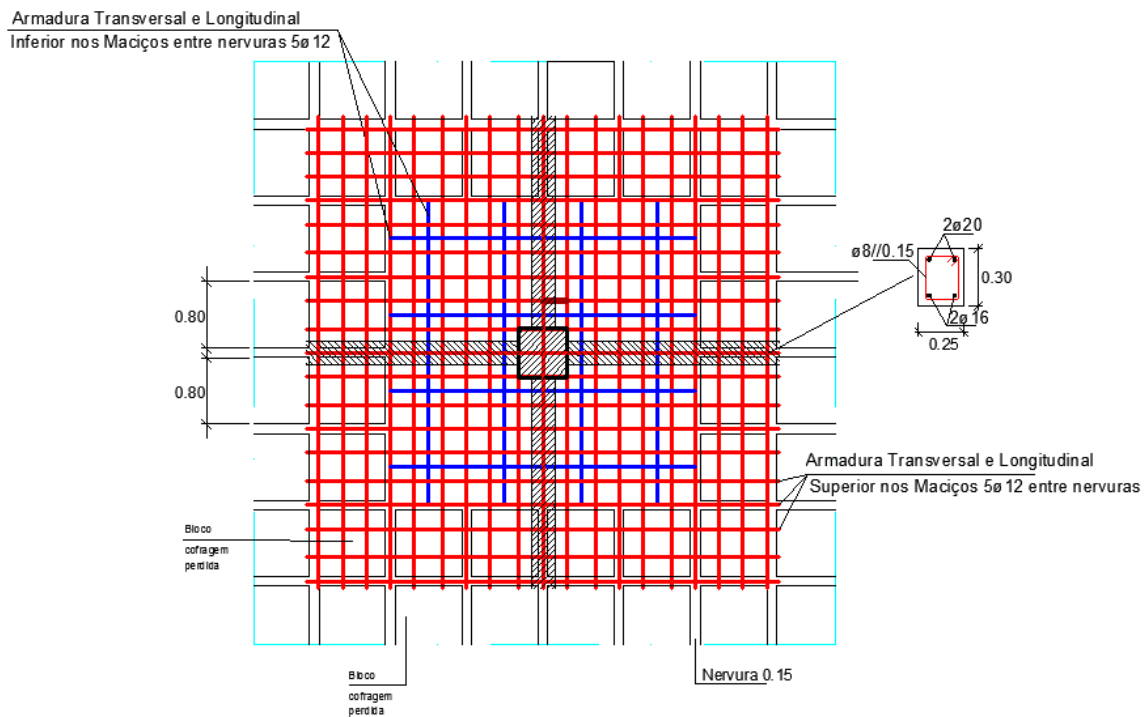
Pormenor do maciço (Fonte: Projeto de Estrutura)
